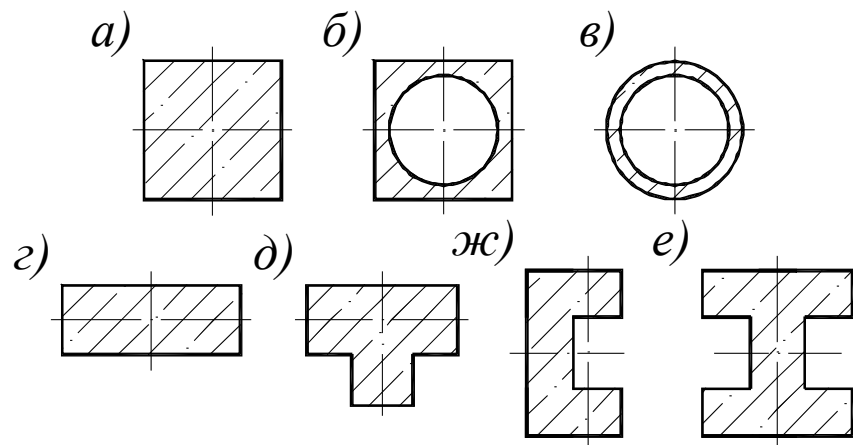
Поперечний переріз: а – квадратні; б – квадратні з круглою порожниною; в – порожнисті круглого перетину; г – прямокутні; д – таврові; е – двотаврові; ж – швелерні
